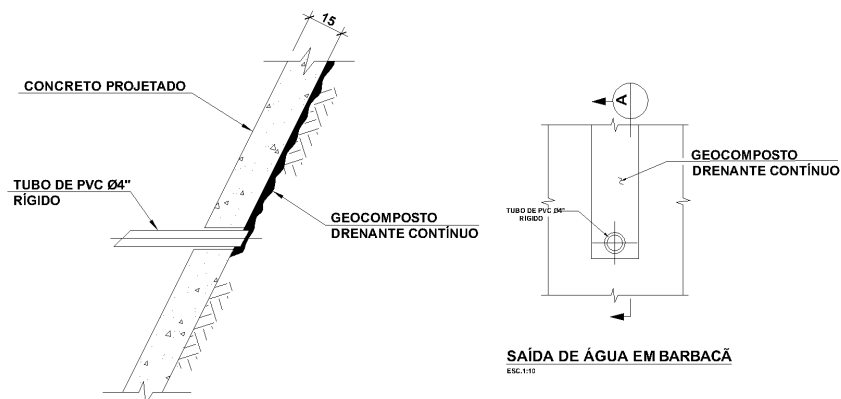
Detalhe da manta geotêxtil atrás do paramento
